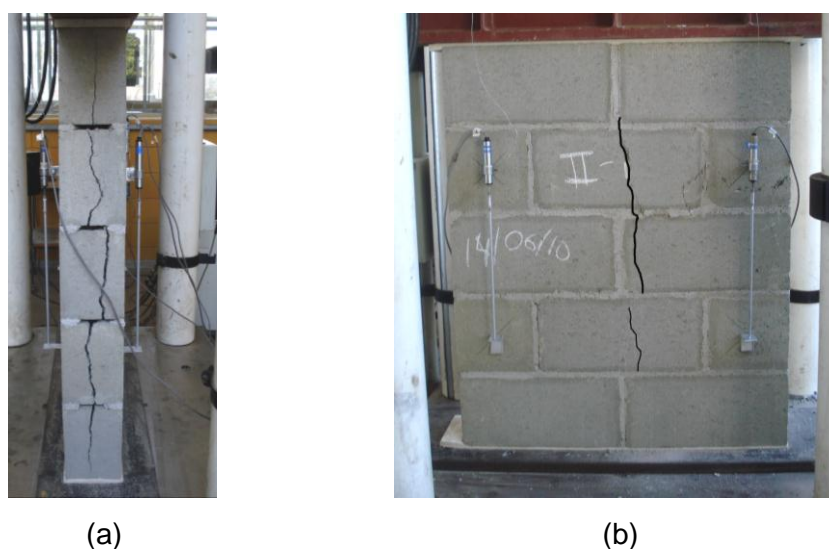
Vista lateral (a) e vista frontal (b) da mini-parede com argamassamento lateral e sem rapaduras (Série II).
